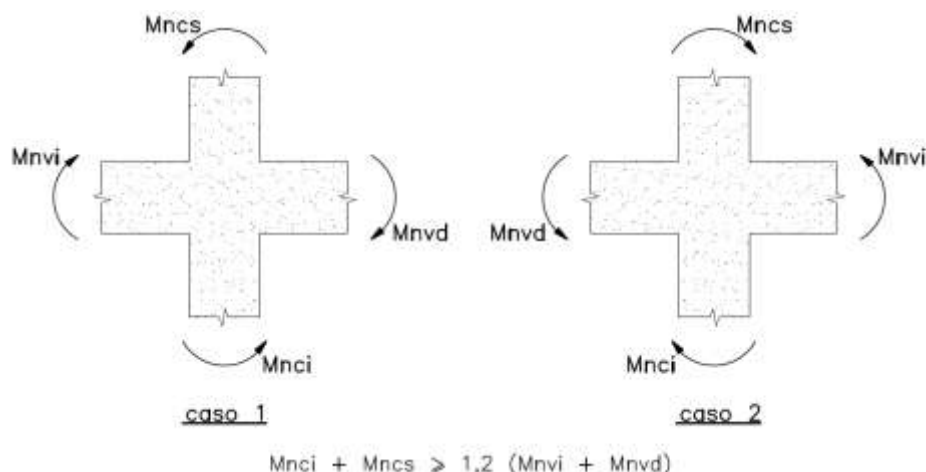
Resistencia a flexión de las columnas en las caras de los nudos
